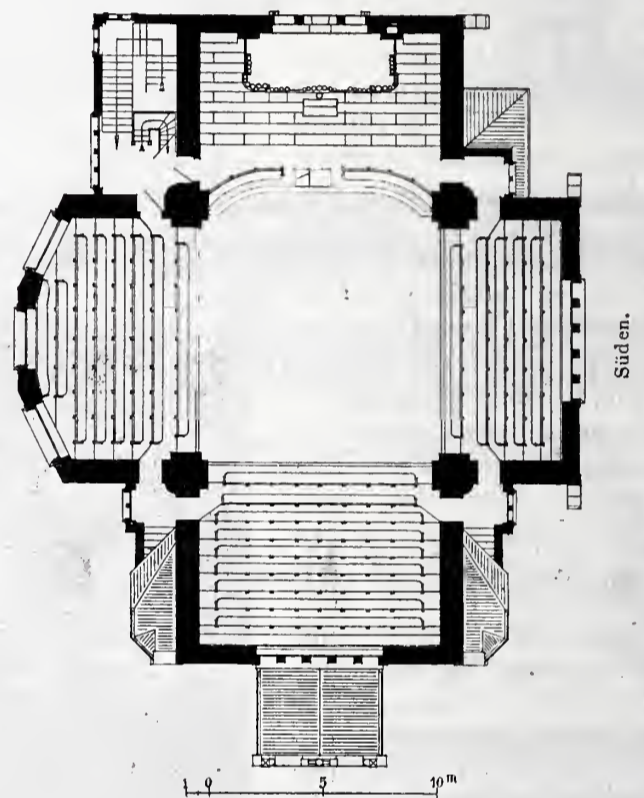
u. 11. Grundrisse vom Erdgeschoss und von der Emporenanlage. — Masstab 1:400.
